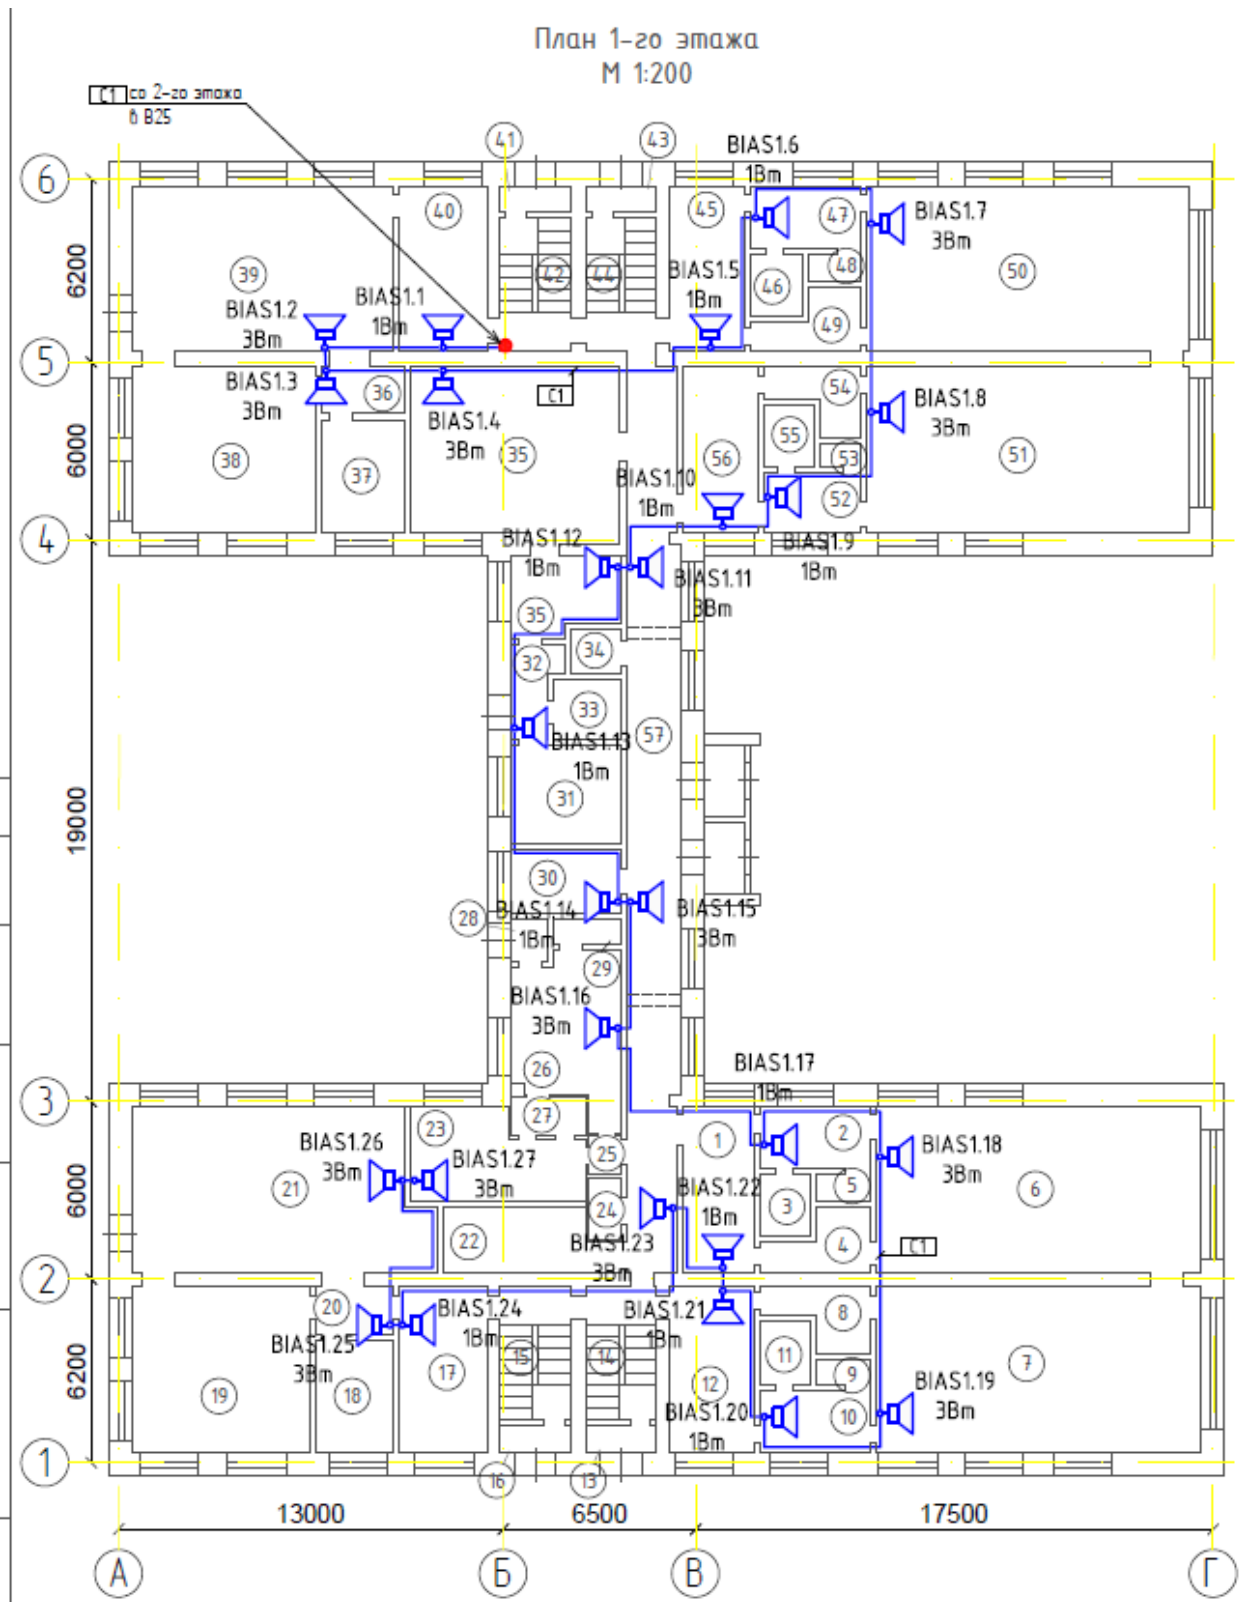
План 1-го этажа сети звукового оповещения о пожаре
